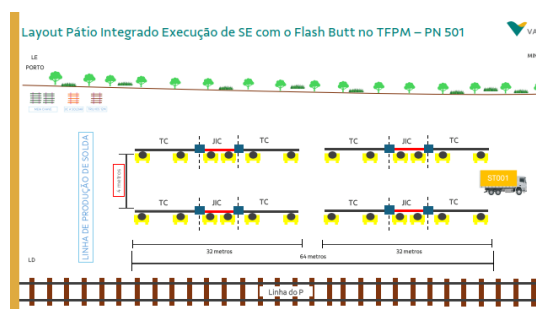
Layout Integrado de Execução de Solda Elétrica em JIC no TFFM
